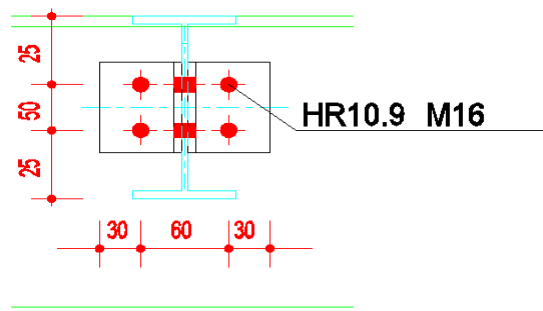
Assemblage poteau-console de la poutre de roulement.
